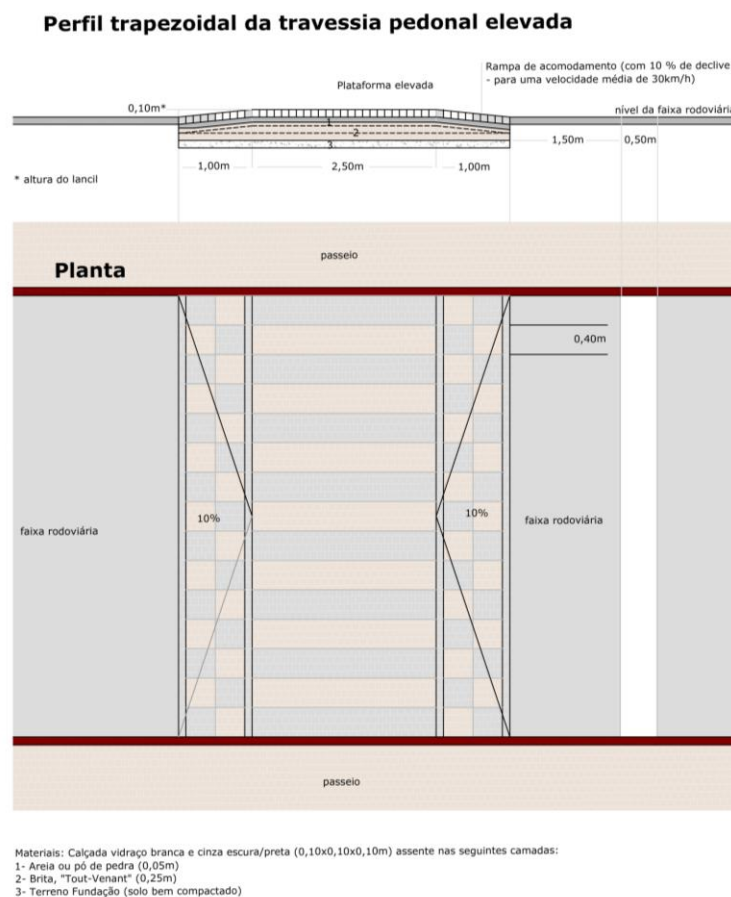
Perfil e planta das passadeiras sobrelevadas.
